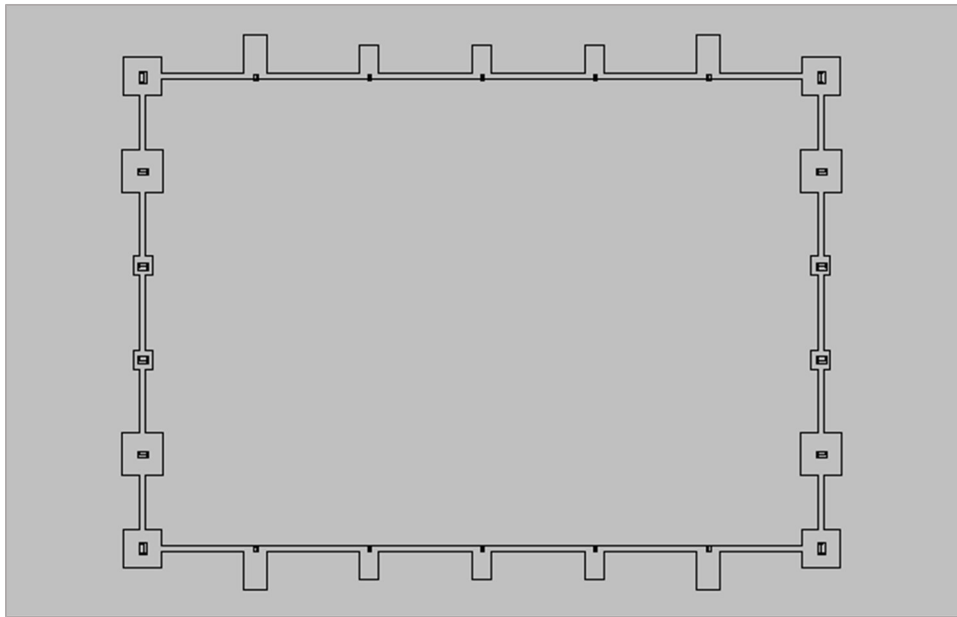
Distribución de las zapatas y vigas de atado nave empotrada.
